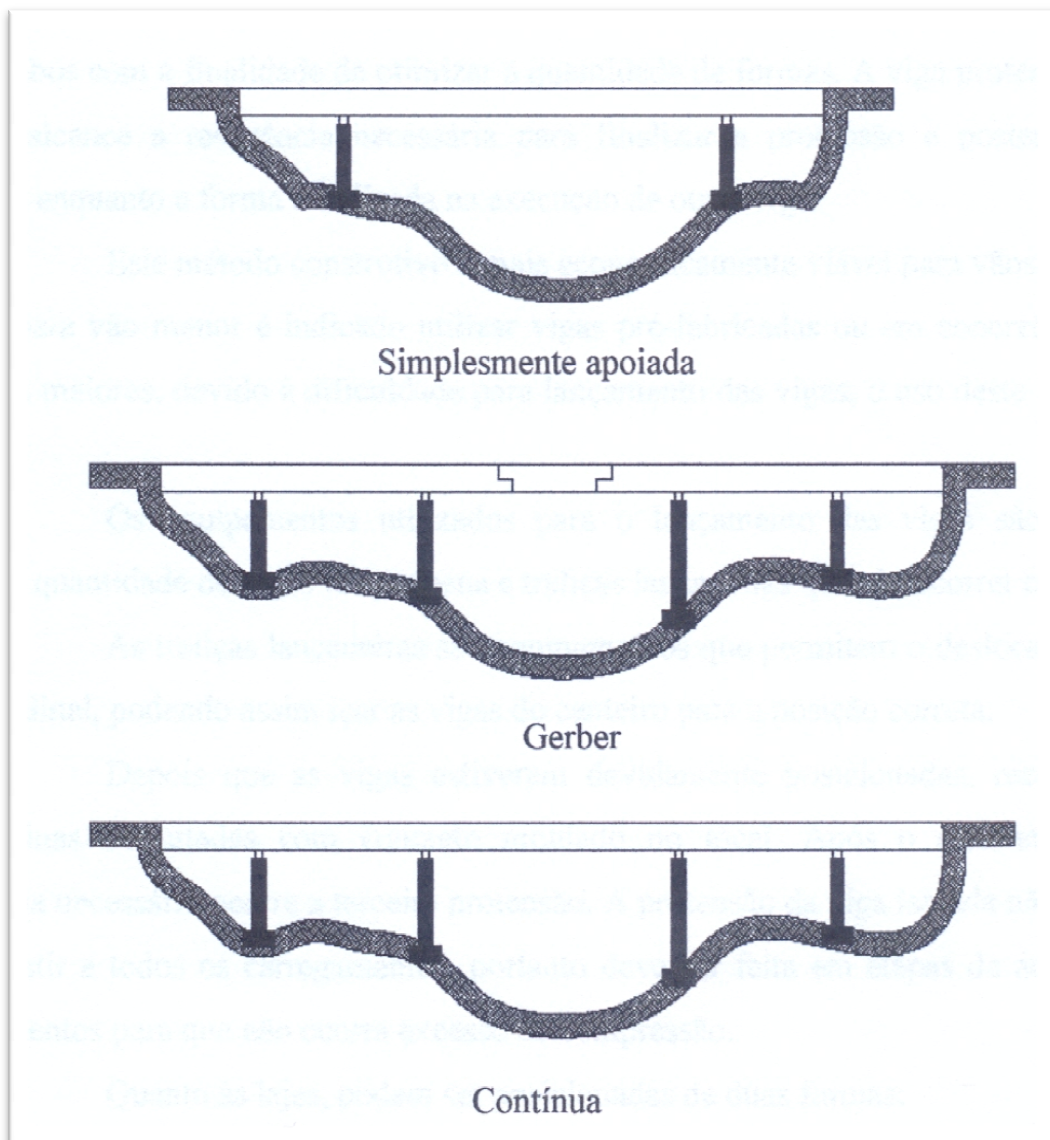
Tipos de pontes em viga (Savelli, 2016)
